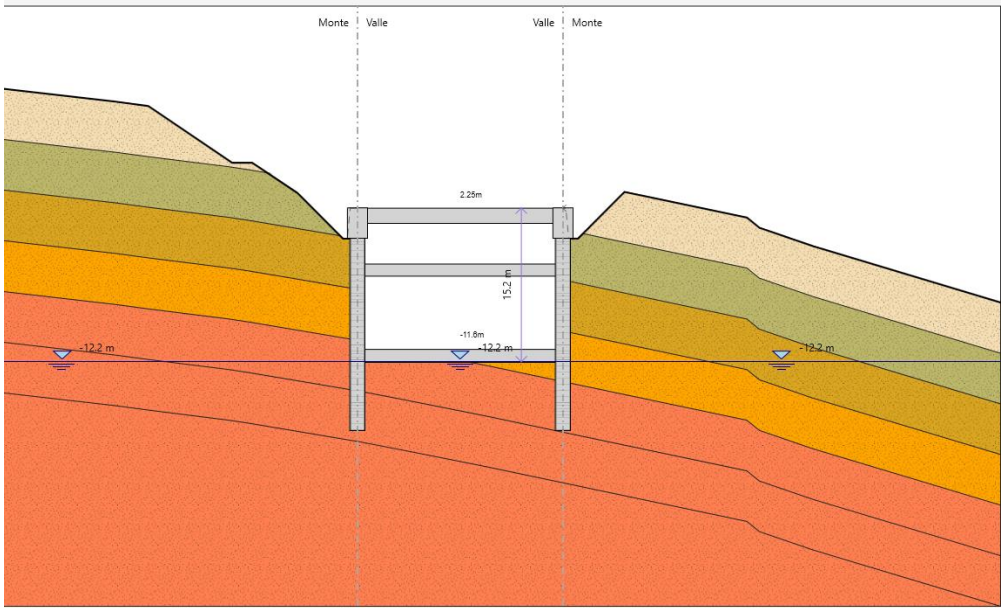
Fase 5-getto della soletta superiore e di quella di fondazione
